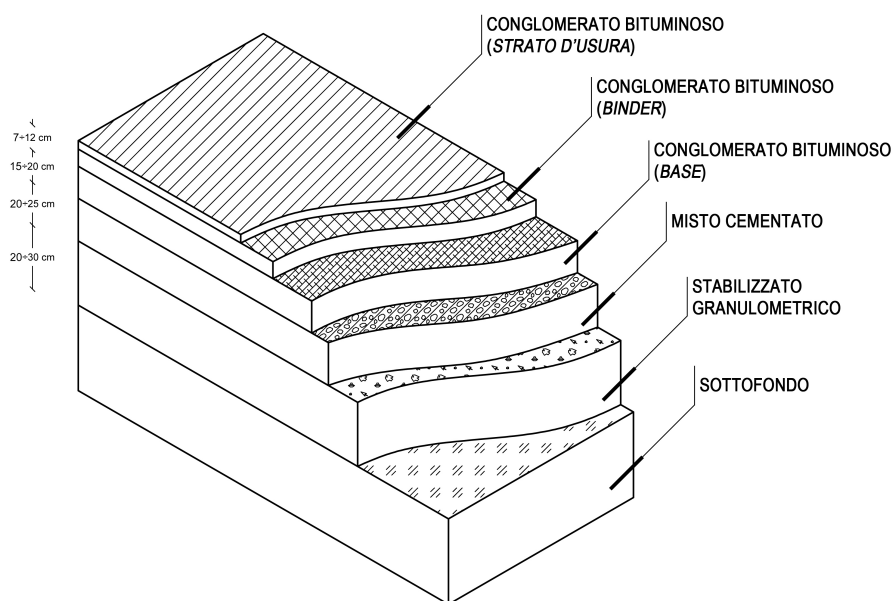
Sezione di una pavimentazione stradale semirigida con sovrastruttura in conglomerato bituminoso
